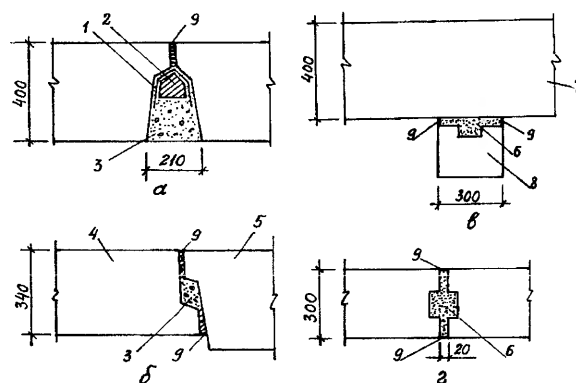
Схема заделки вертикальных стыков между блоками: а – простеночными на глухих участках стен; б – простеночными и подоконными; в – простеночным и блоком внутренней стены; г – внутренних стен; 1 – два слоя рубероида; 2 – утеплитель, обернутый толем; 3 – легкий бетон; 4 – подоконный блок; 5 – простеночный блок; 6 – раствор; 7 – блок наружной стены; 9 – зачеканка раствором
